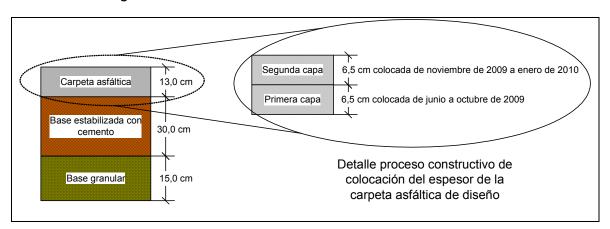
Paquete estructural aprobado para la Sección II presentado en el Volumen 2 del "Diseño Estructural de Pavimentos: Autopista San José-Caldera"
